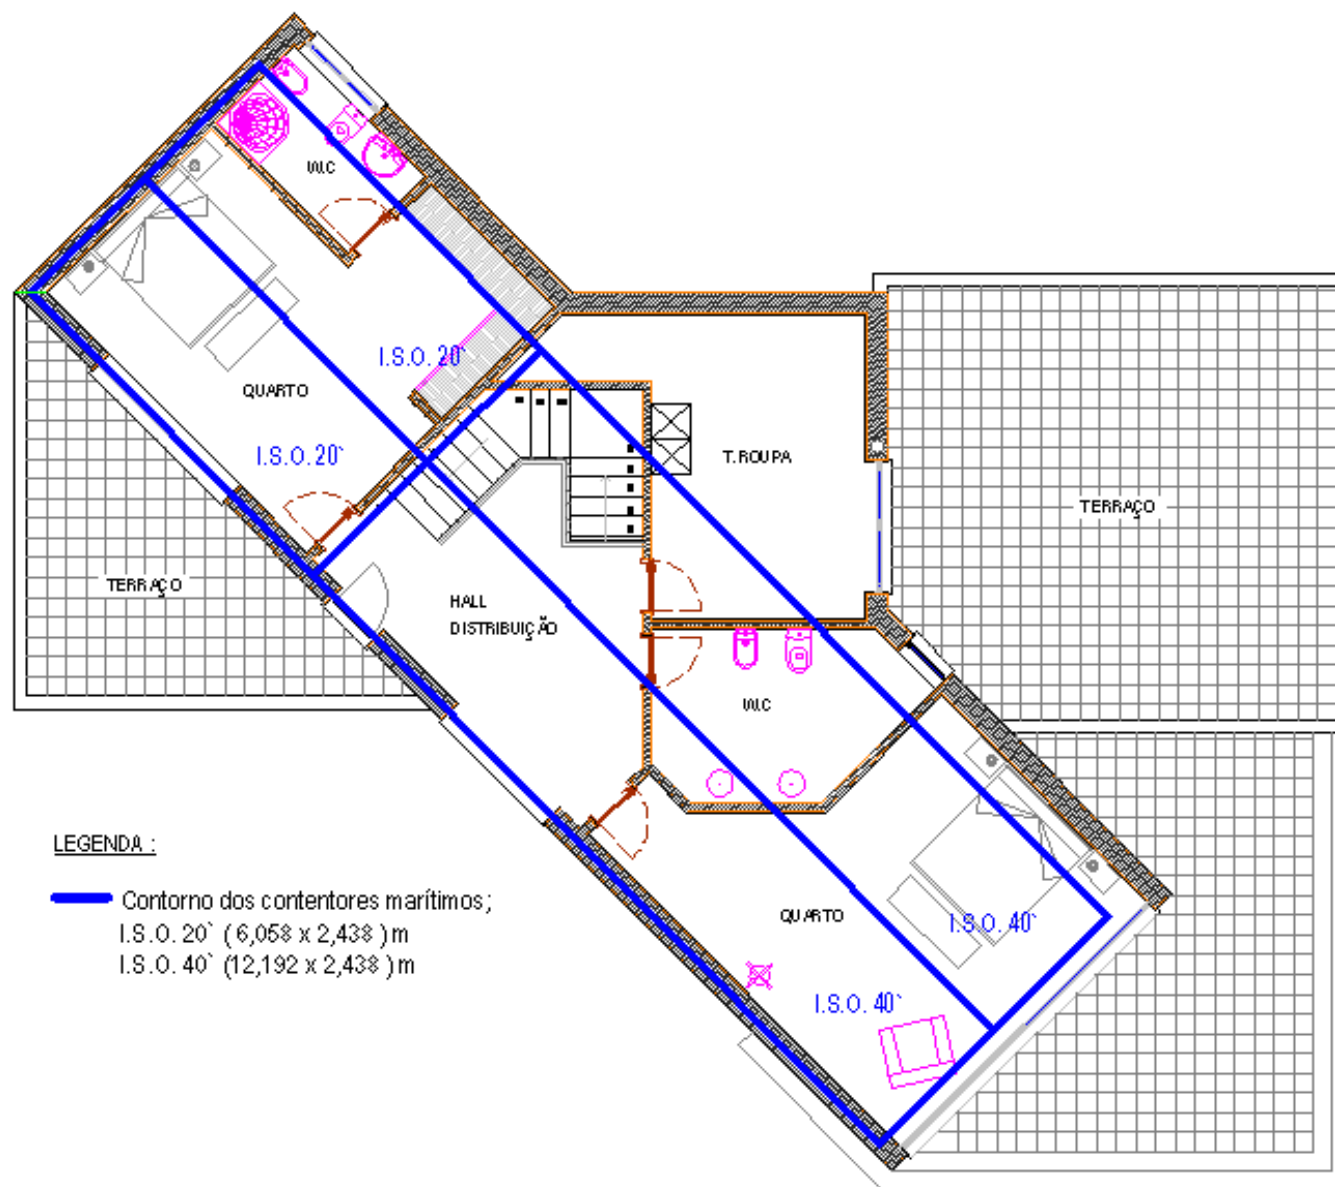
Proposta de construção modular com contentores marítimos, planta do 1º andar
